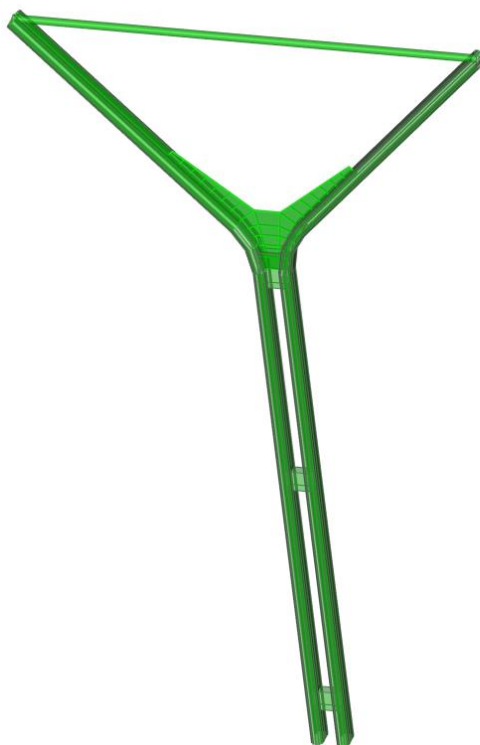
| Captura de SAP2000: Detalle de un pilar “Y”. (elaboración propia)
